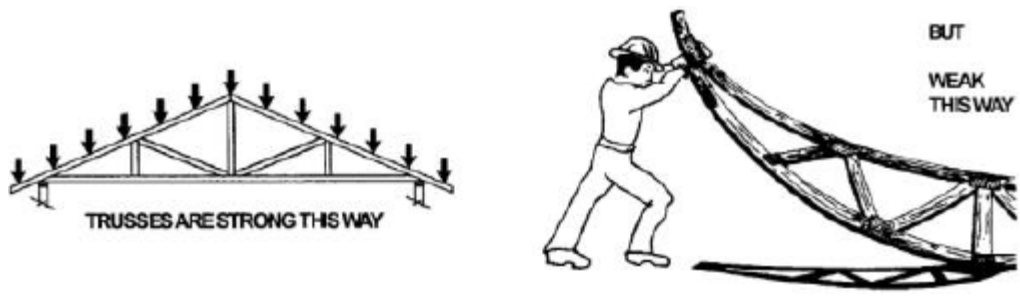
Baixa rigidez lateral das treliças (Fonte: Truss Plate Institute)
